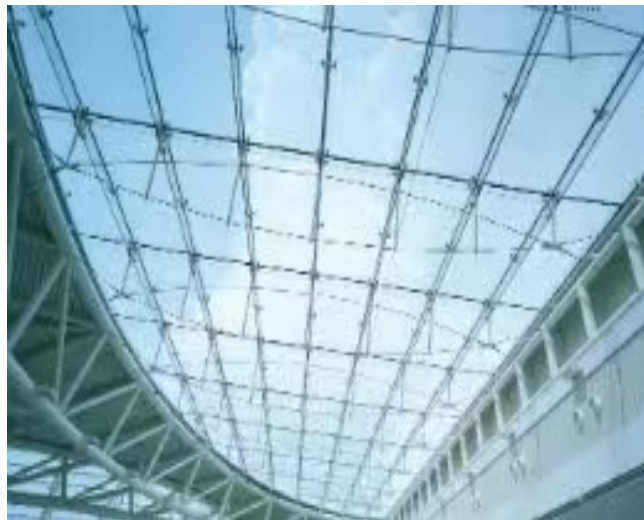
Вантова (планарная) схема скління фасаду
